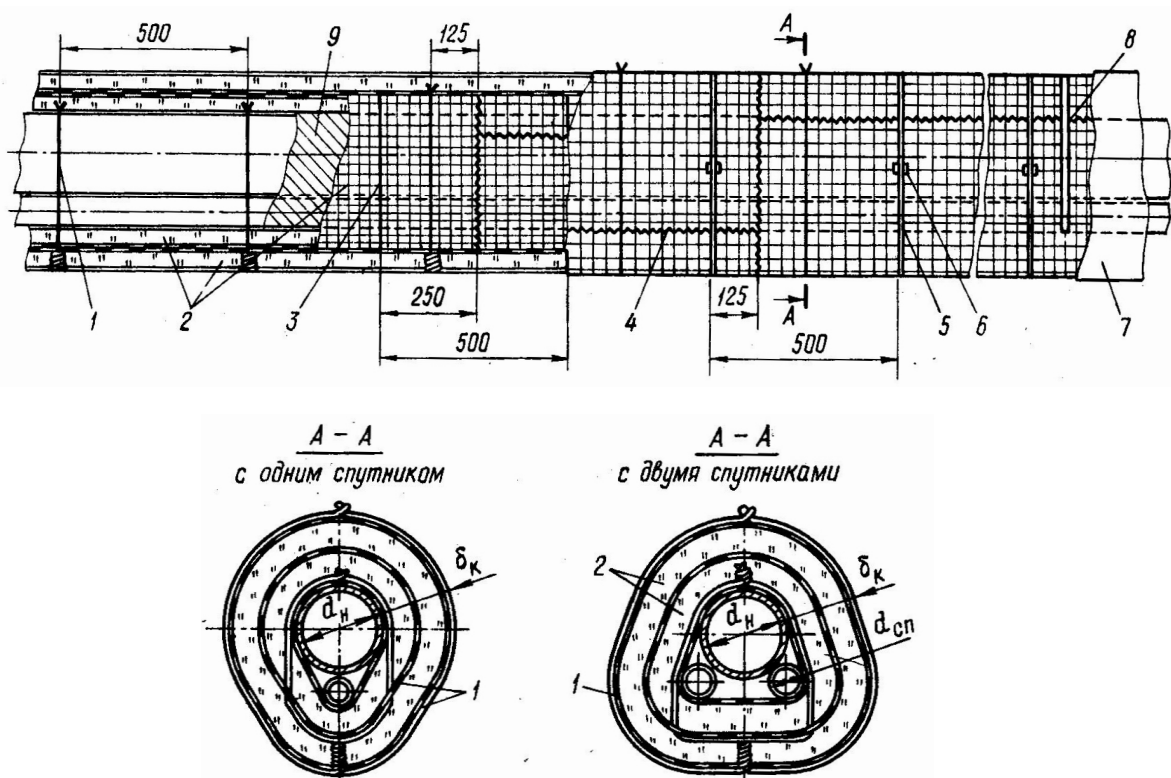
Тепловая изоляция трубопроводов диаметром от 273 мм до 820 мм со спутниками матами прошивными в обкладках
